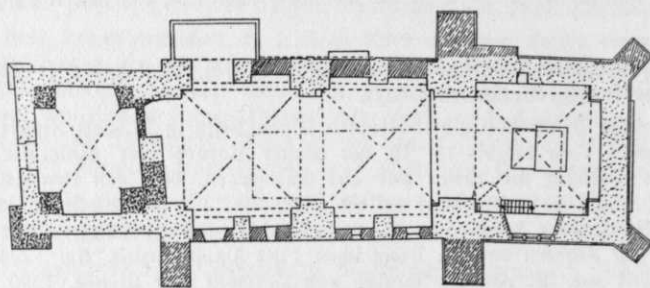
Mühlhausen, Grundriß der Kirche. 1:300
